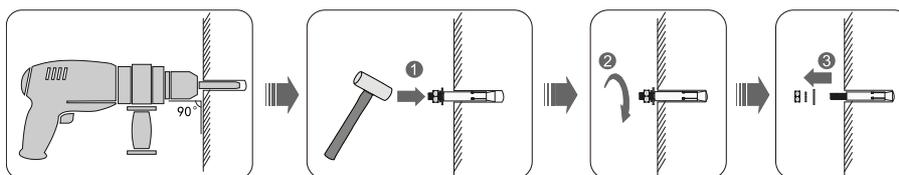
Einschieben der Schrauben in die Bohrlöcher
